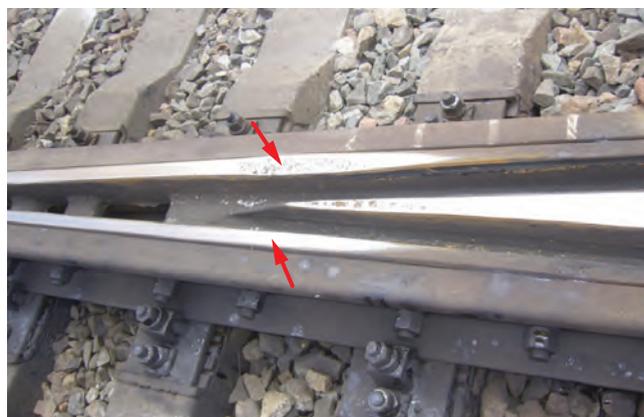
Сплывы и выкрашивание металла на рабочих поверхностях крестовин типа P65 из-за воздействия колес с повышенной нагрузкой
